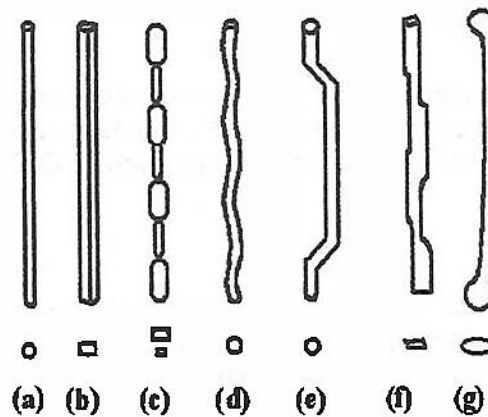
Formas de las fibras de acero: a) sección circular; b) sección rectangular; c) dentada; d) ondulada; e) extremos conformados; f) de raspado en caliente; g) extremos ensanchados. (ACHE, 2000)
